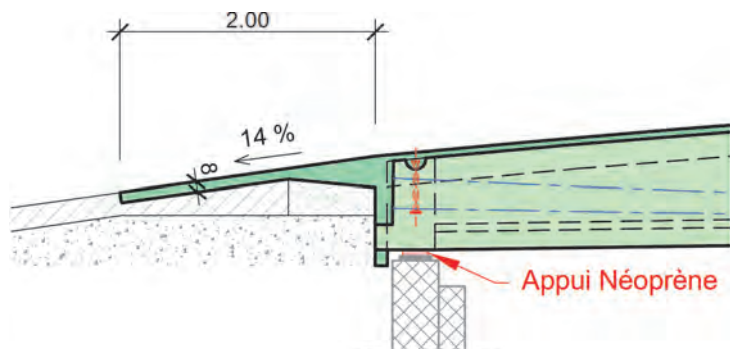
Dalle de transition en CFUP (extrait plan d'exécution OPAN concept)
